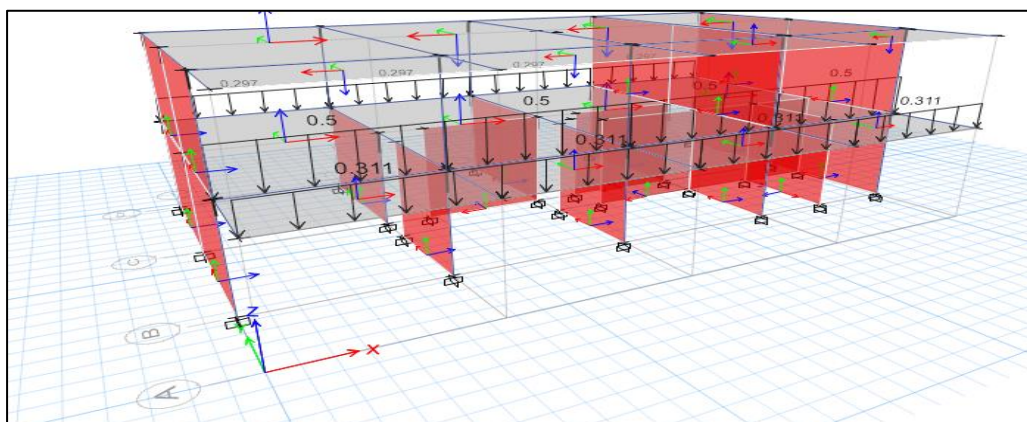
Cargas distribuidas de parapetos y tabiquería en eje B y D del pabellón 4
